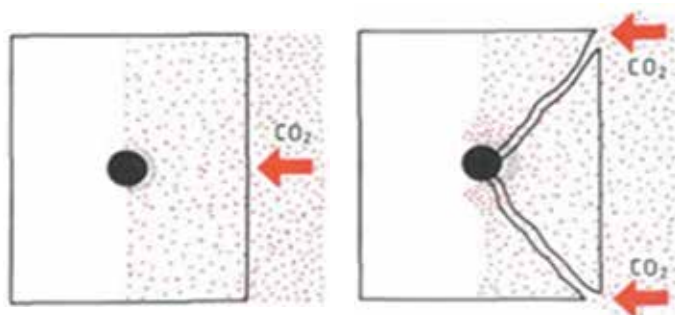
Коррозия железобетонной конструкции, включающая разрушения бетона и арматуры.
